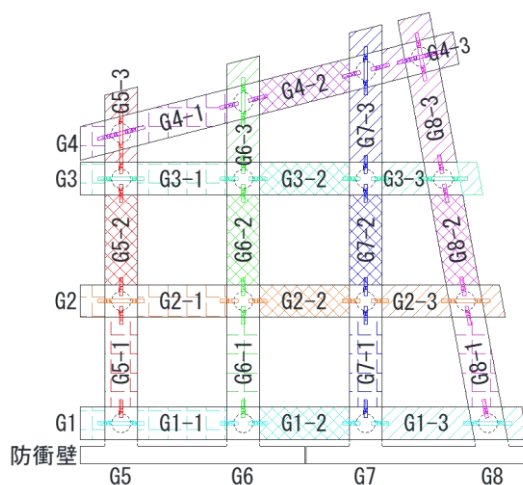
PCa 梁タイプ別平面配置図 (E スパン)
